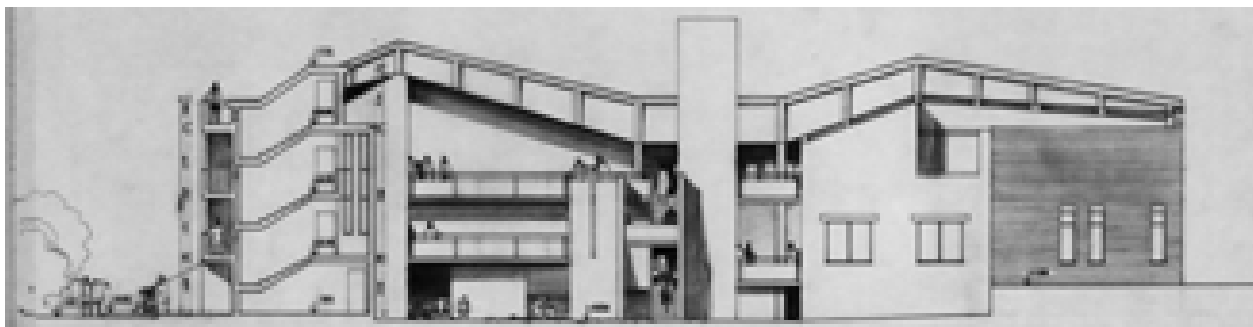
Prospetto Sud, stato attuale –09/12/1997 (AABS-1996.992)
